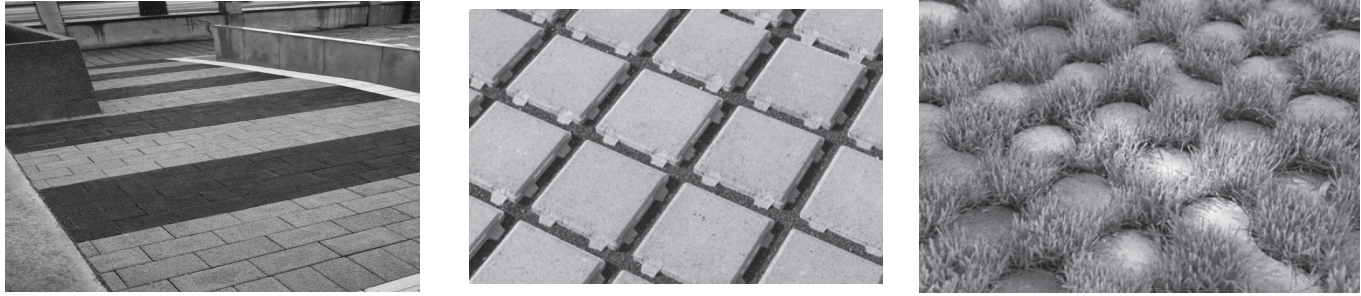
Pavés en béton poreux, pavés à joints larges, dalles drainantes
